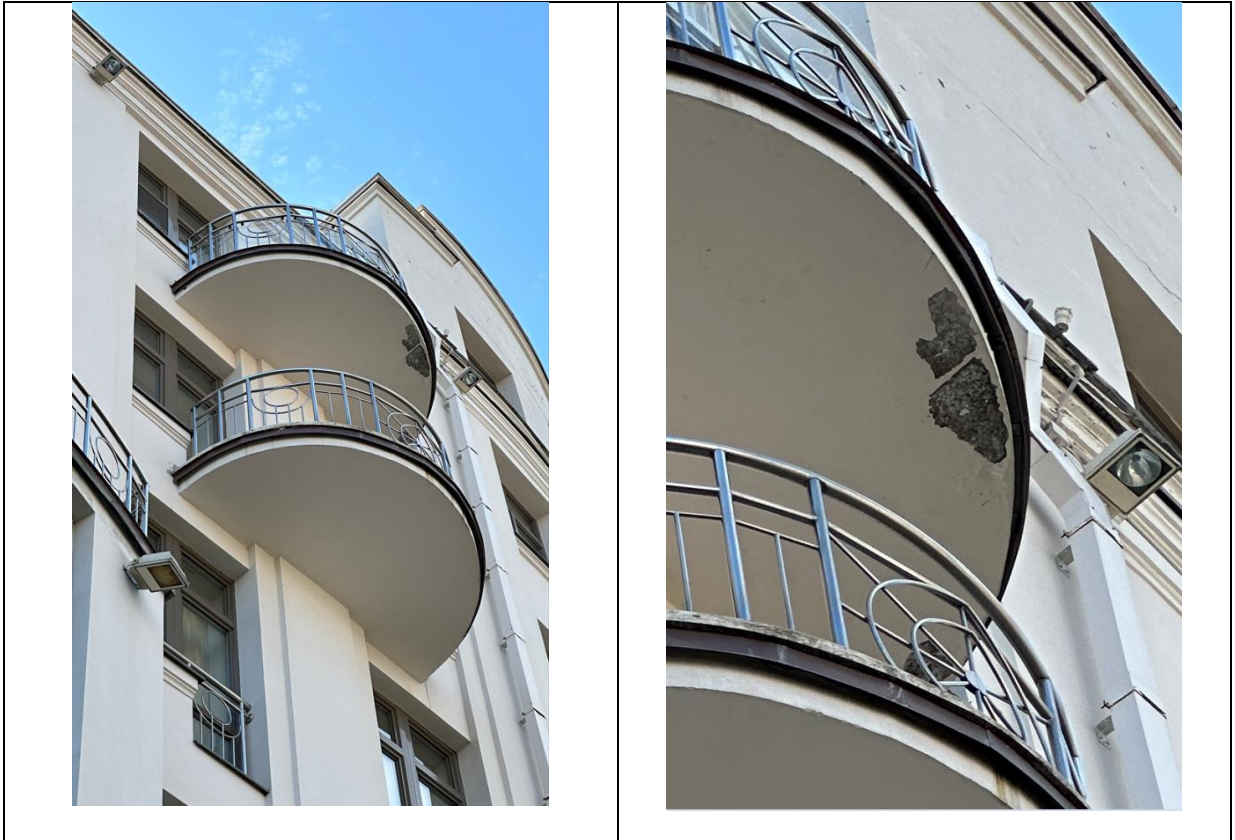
Виды дефектов фасада в виде отслоения плит натурального камня.
